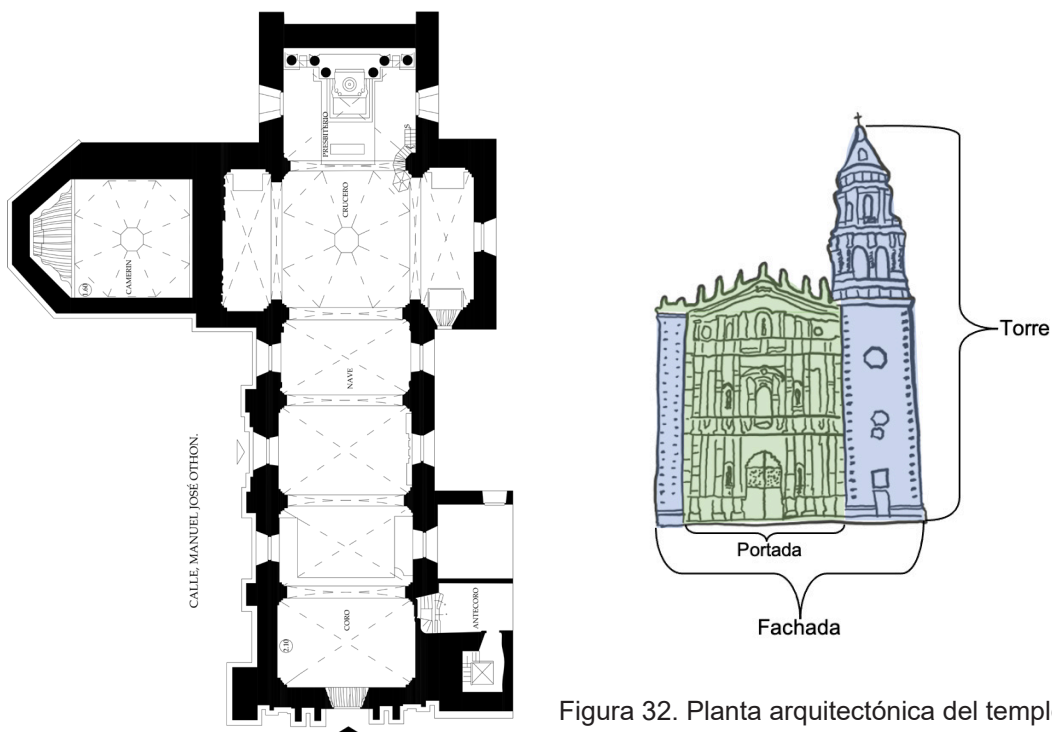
Planta arquitectónica del templo del Carmen proporcionado por INAH
